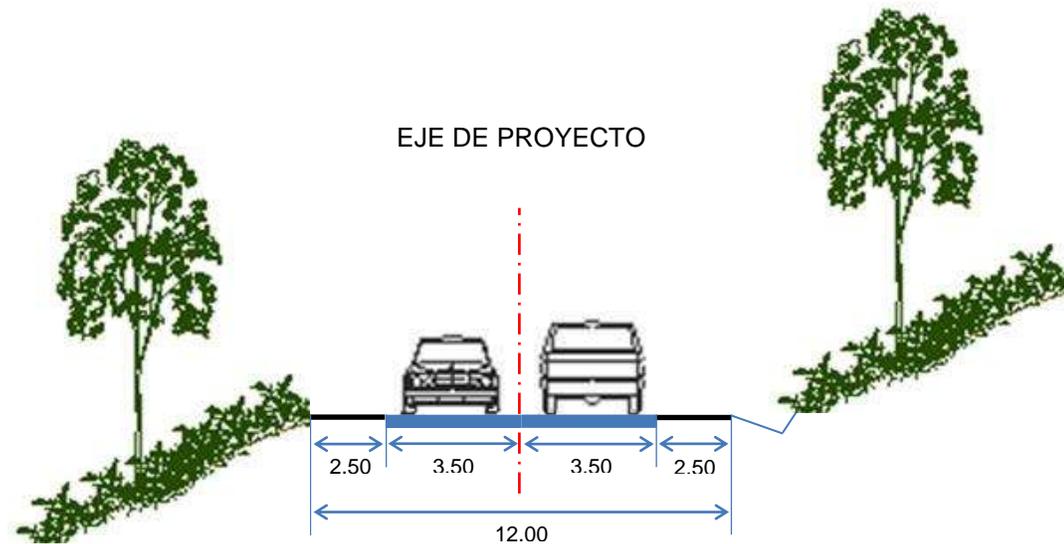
Sección tipo de construcción del tramo 1 acotaciones en metros.
